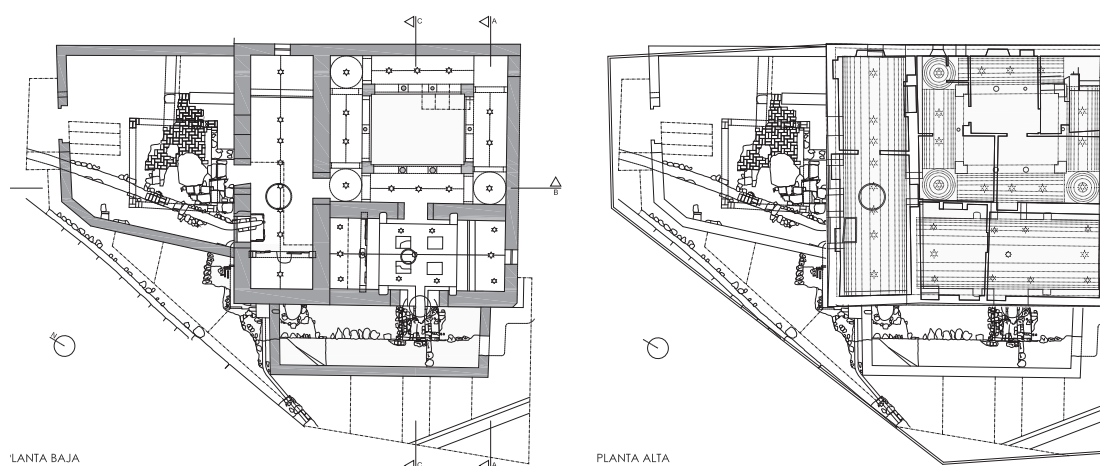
Plantas baja y alta de los baños árabes de Baza. Planimetría: Francisco Ibáñez.
